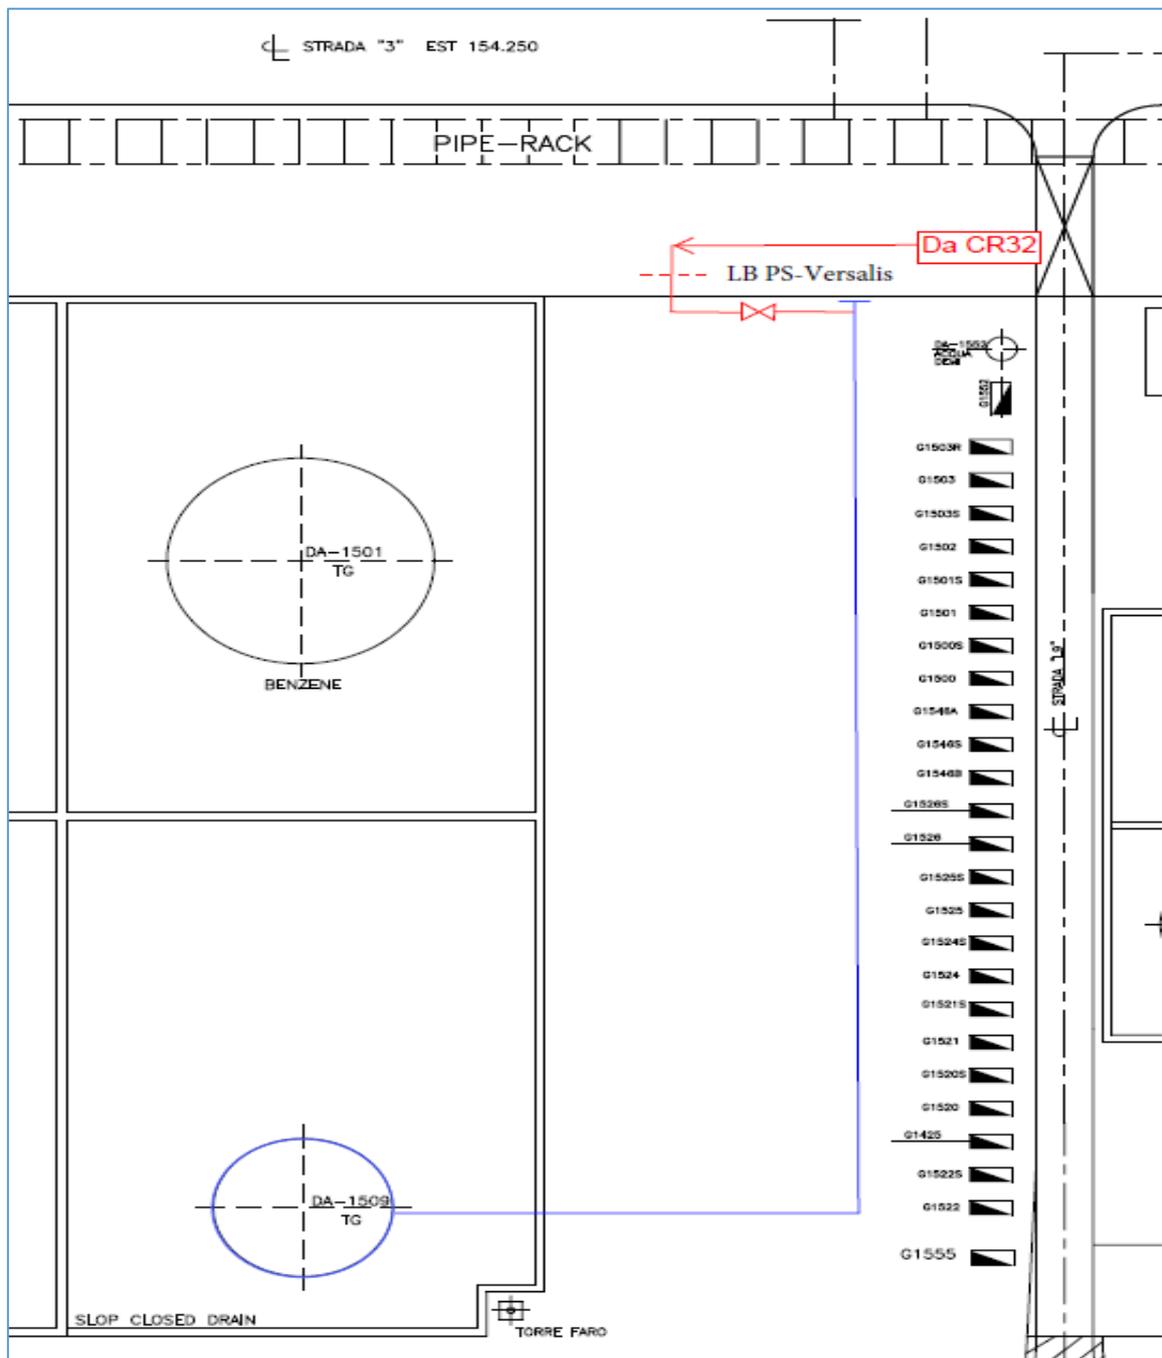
Posizionamento planimetrico serbatoio DA1509 area stoccaggi CR15 Impianti Aromatici
